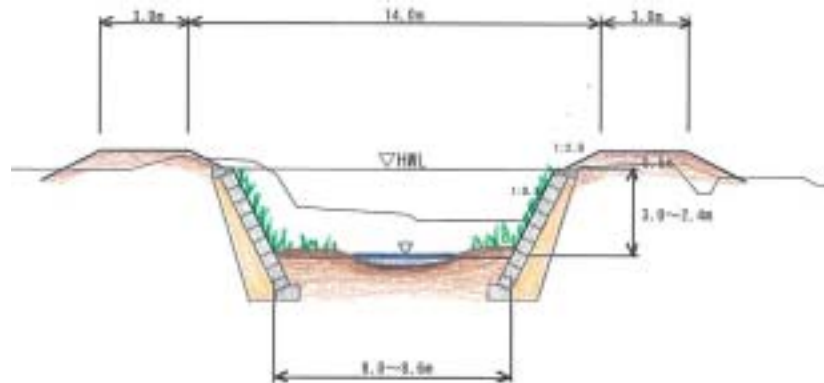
多田川標準断面図（横断面はイメージを表す）
